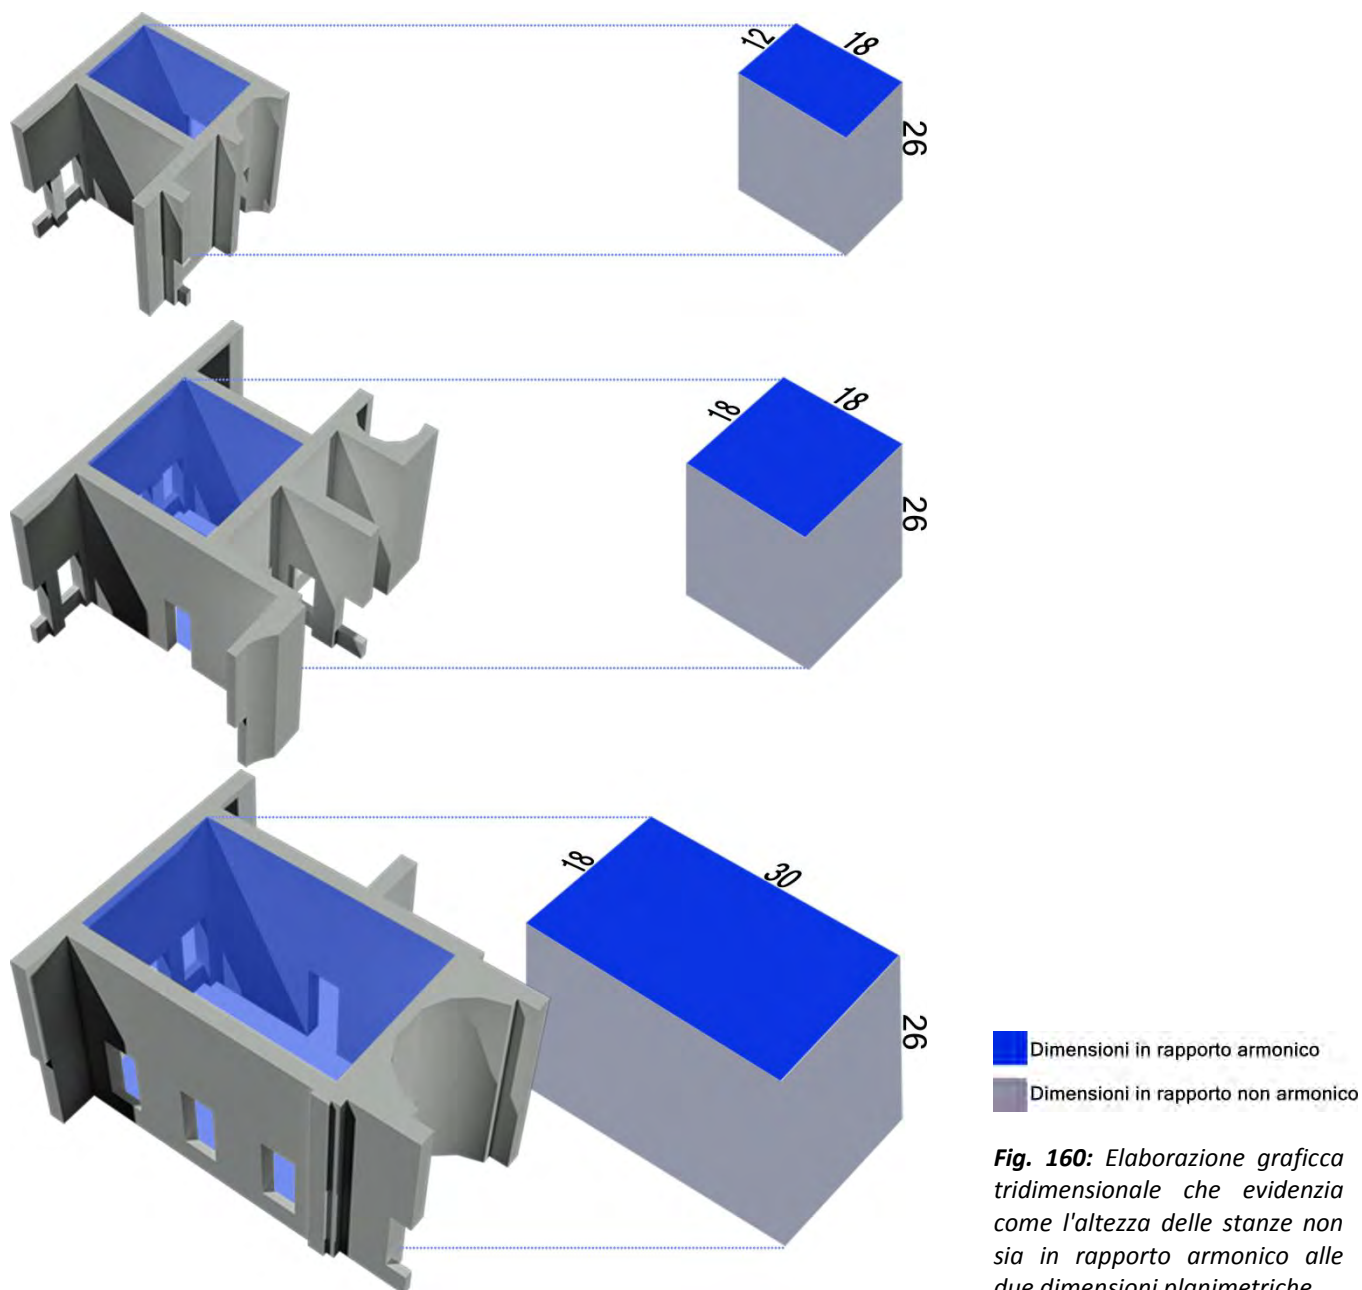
Elaborazione grafica tridimensionale che evidenzia come l'altezza delle stanze non sia in rapporto armonico alle due dimensioni planimetriche
